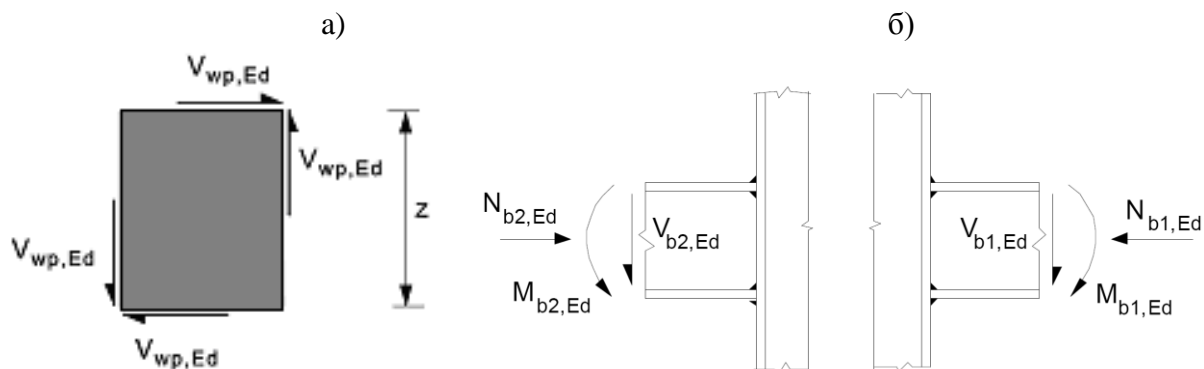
Внутренние усилия, действующие на участках стенки колонны в узловых соединениях: а) – поперечные силы на участке стенки колонны, б) – усилия в узле сопряжения балки с колонной
